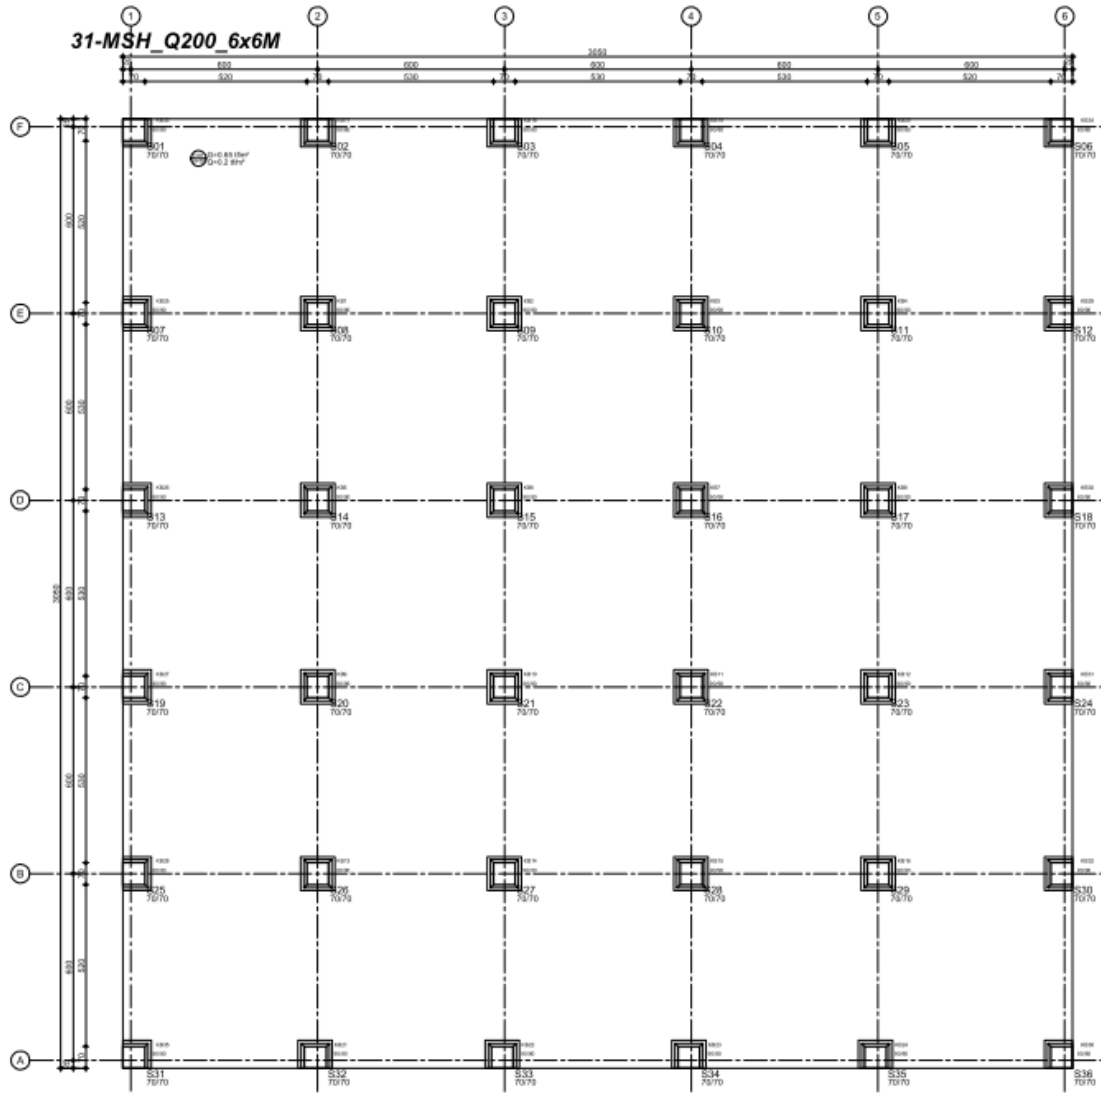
Bir Doğrultuda Dişli Döşeme Sistemi (Nervürlü Döşeme) Örnek Kalıp Planı (RIB)
